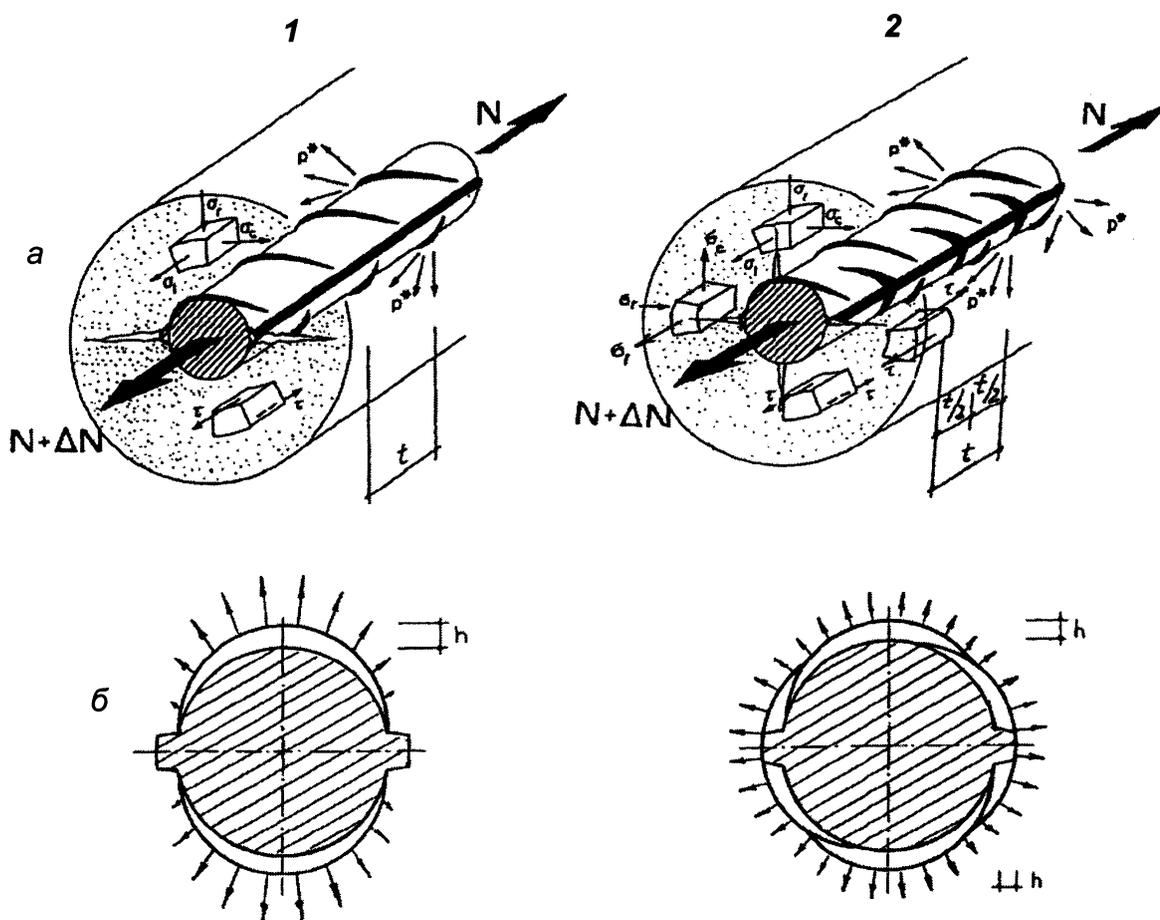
Схема взаимодействия растянутого арматурного стержня с окружающим бетоном: 1 – европейский профиль с серповидными ребрами; 2 – профиль нового типа; а – усилия в бетоне в зоне передачи напряжений с арматуры на бетон; б – распределение усилий распора в поперечном сечении
